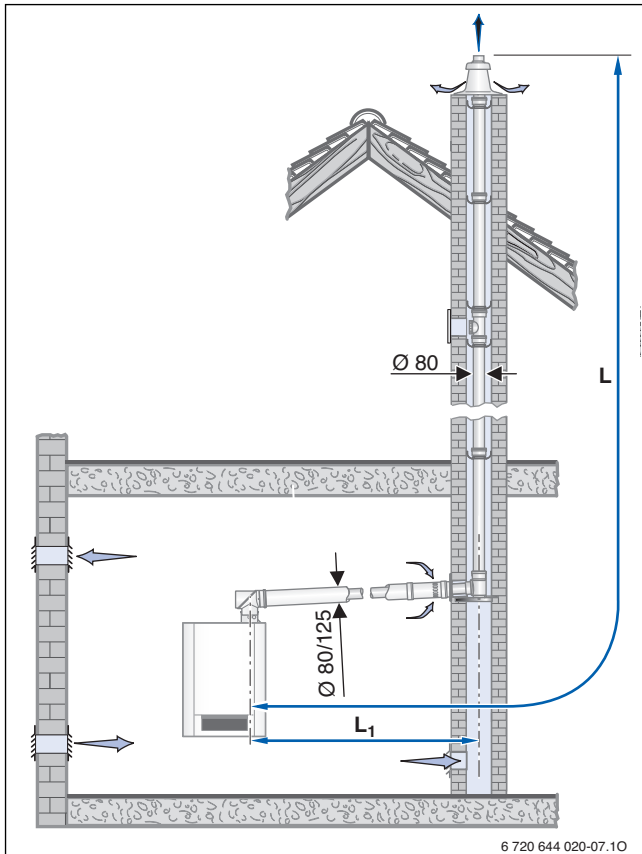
Montagevariante mit dem Bausatz GA-X + GA-K
